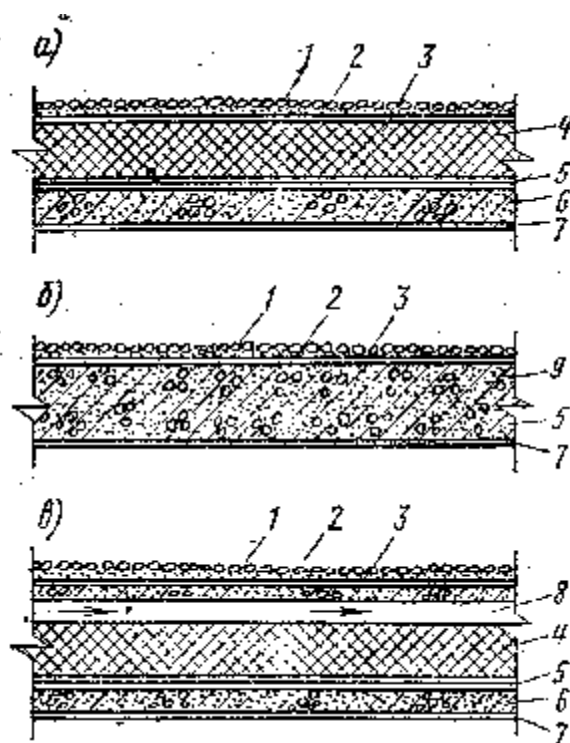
Принципиальная конструктивная схема совмещенных крыш:а - неventилируемой с теплоизоляцией, раздельной от несущей конструкции крыши; б- то же, совмещенной с несущей конструкцией; в - вентилируемой; 1- защитный слой; 2 - рулонный ковер; 3-стяжка;4-теплоизоляция;5-пароизоляция; 6-несущая конструкция; 7 –отделочный слой; 8- воздушная прослойка; 9- теплоизоляционный несущий слой
